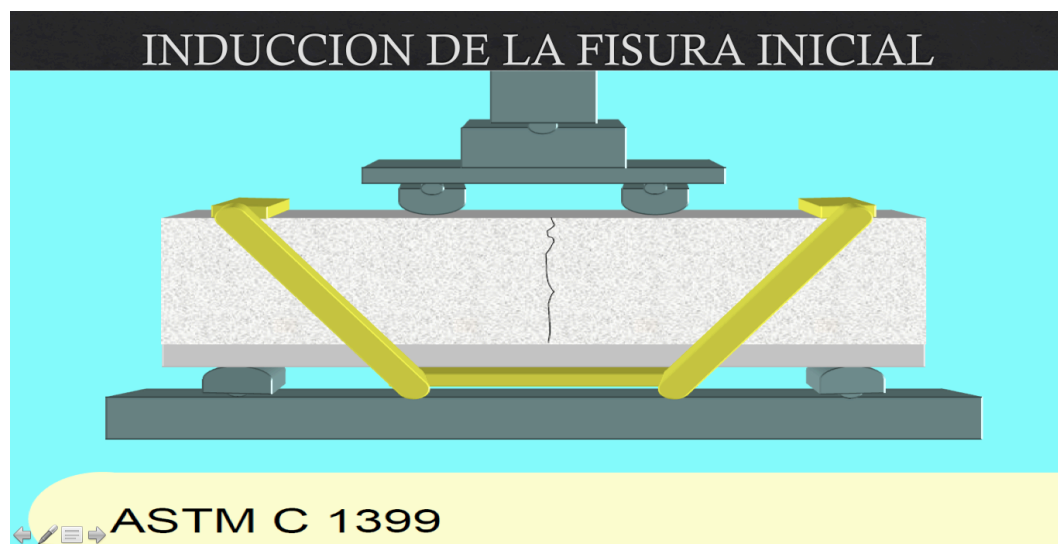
Esquema de fisuración controlada en la viga de concreto.<sup>47</sup>
